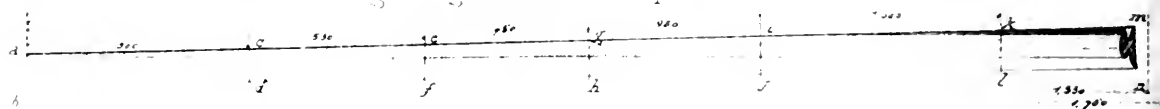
& 11. Châssinet de changement de voie. Elevations à 0.20 p^r 1^m
